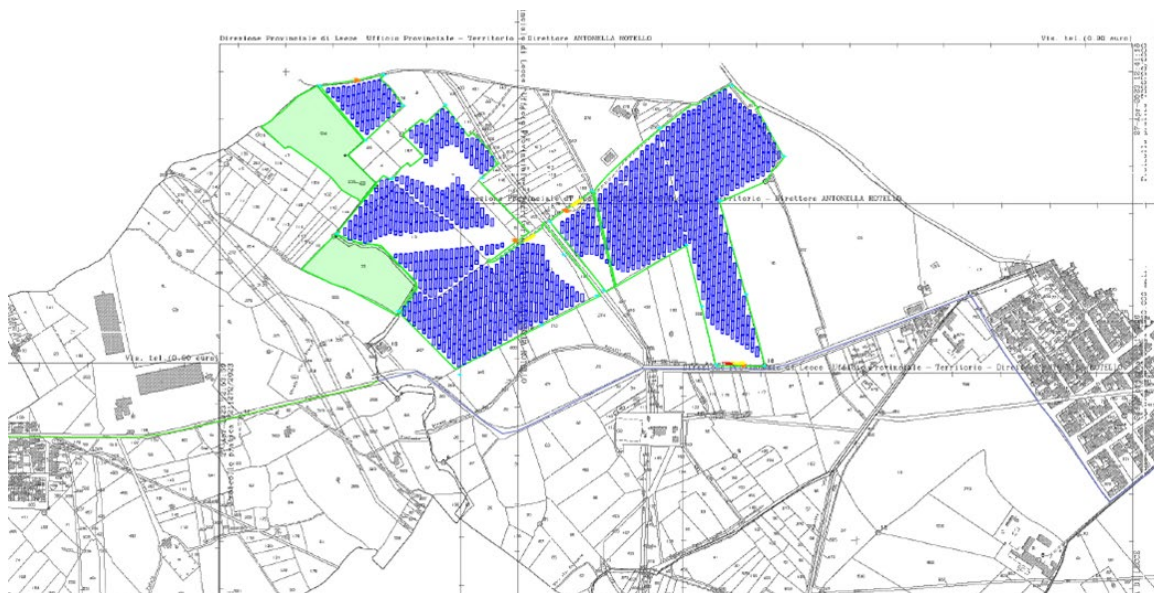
Inquadramento delle aree di Progetto su base catastale (Lotto 1) – Stralcio
